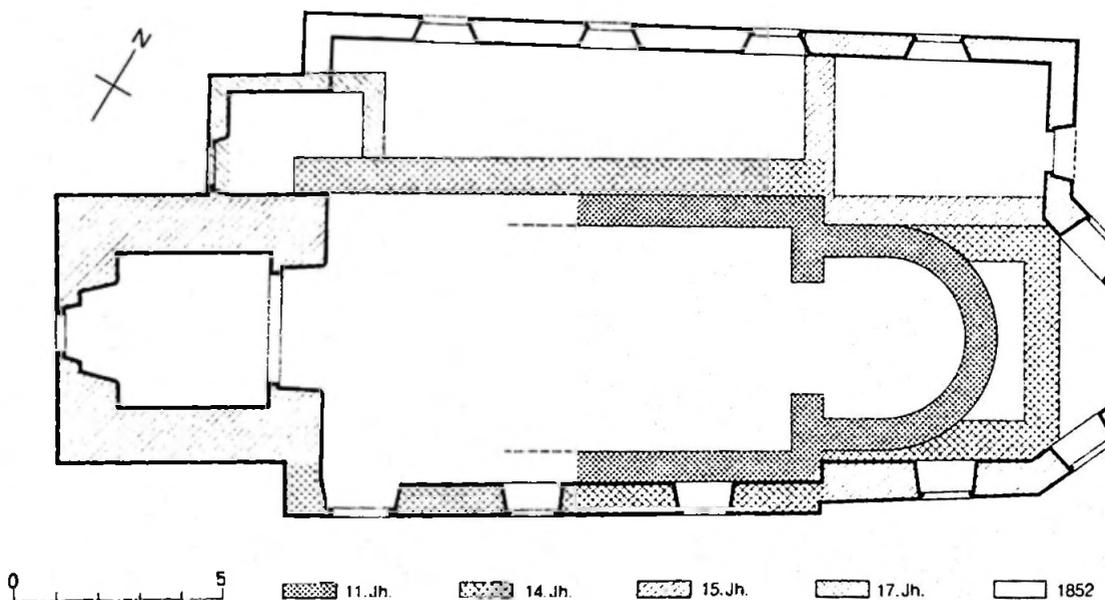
Oltingen. Kirche. Grundriß mit Bautappen. Maßstab 1:200. - Text S. 165f. und oben.
